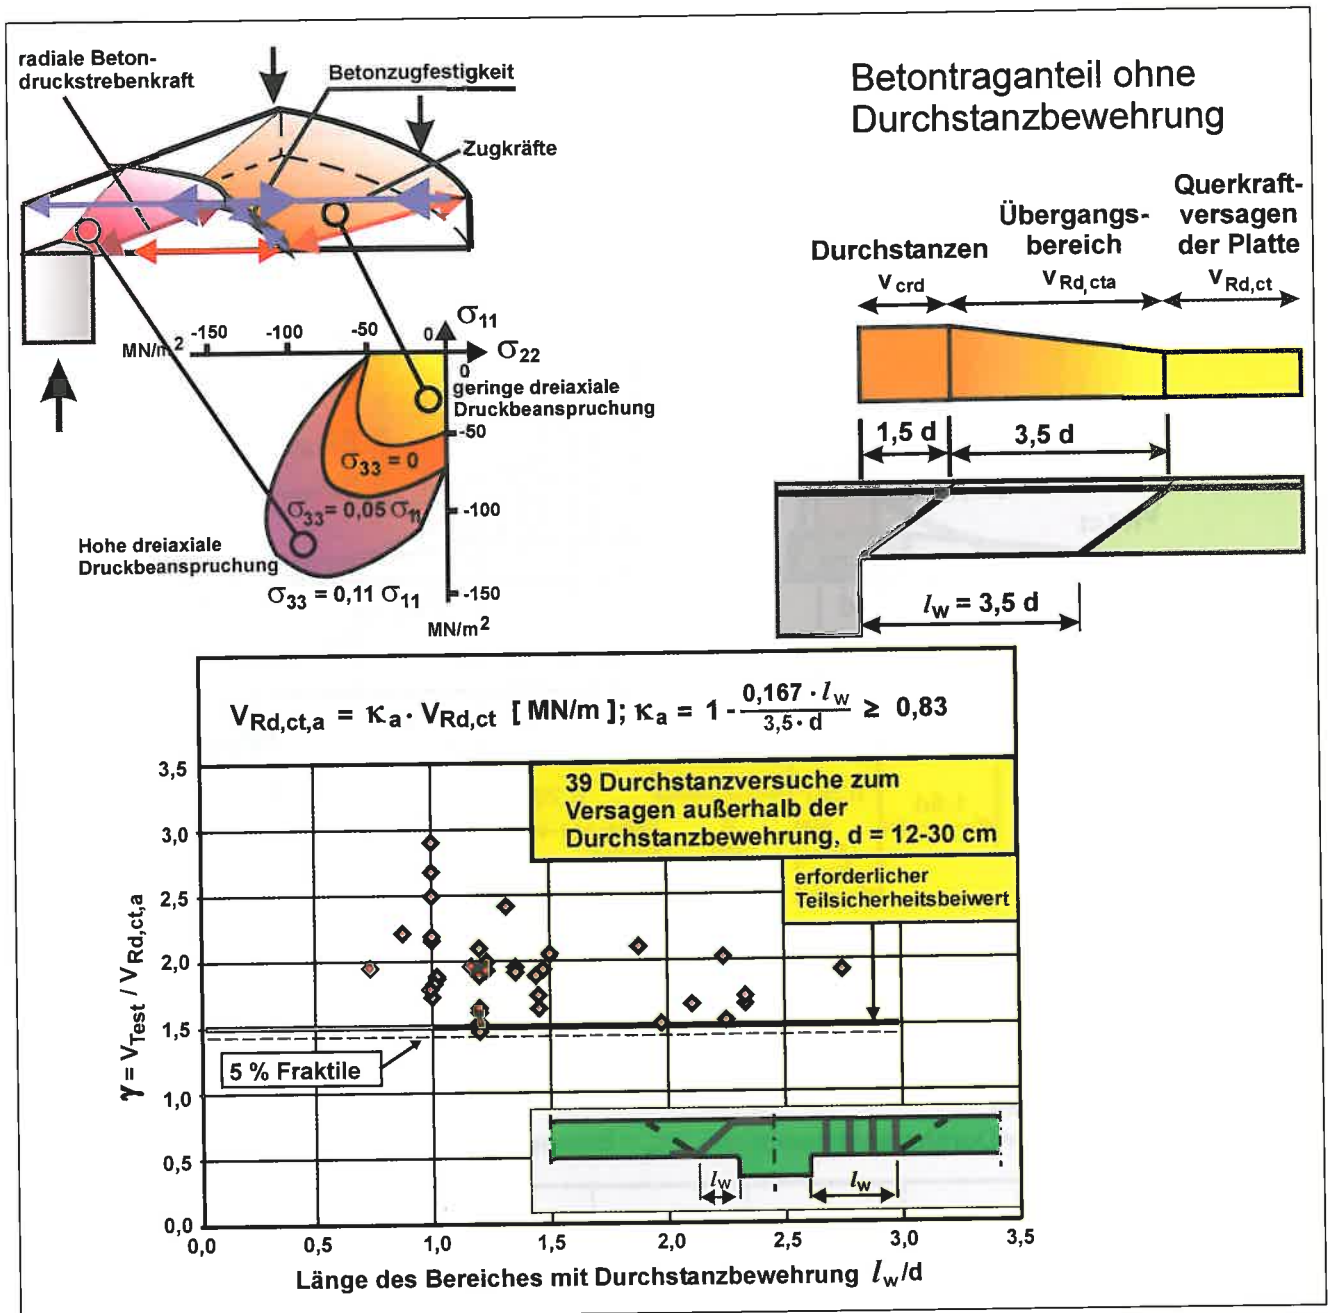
Bemessungsgleichung und Versuchsnachrechnung zum Versagen außerhalb des Durchstanzbereiches
